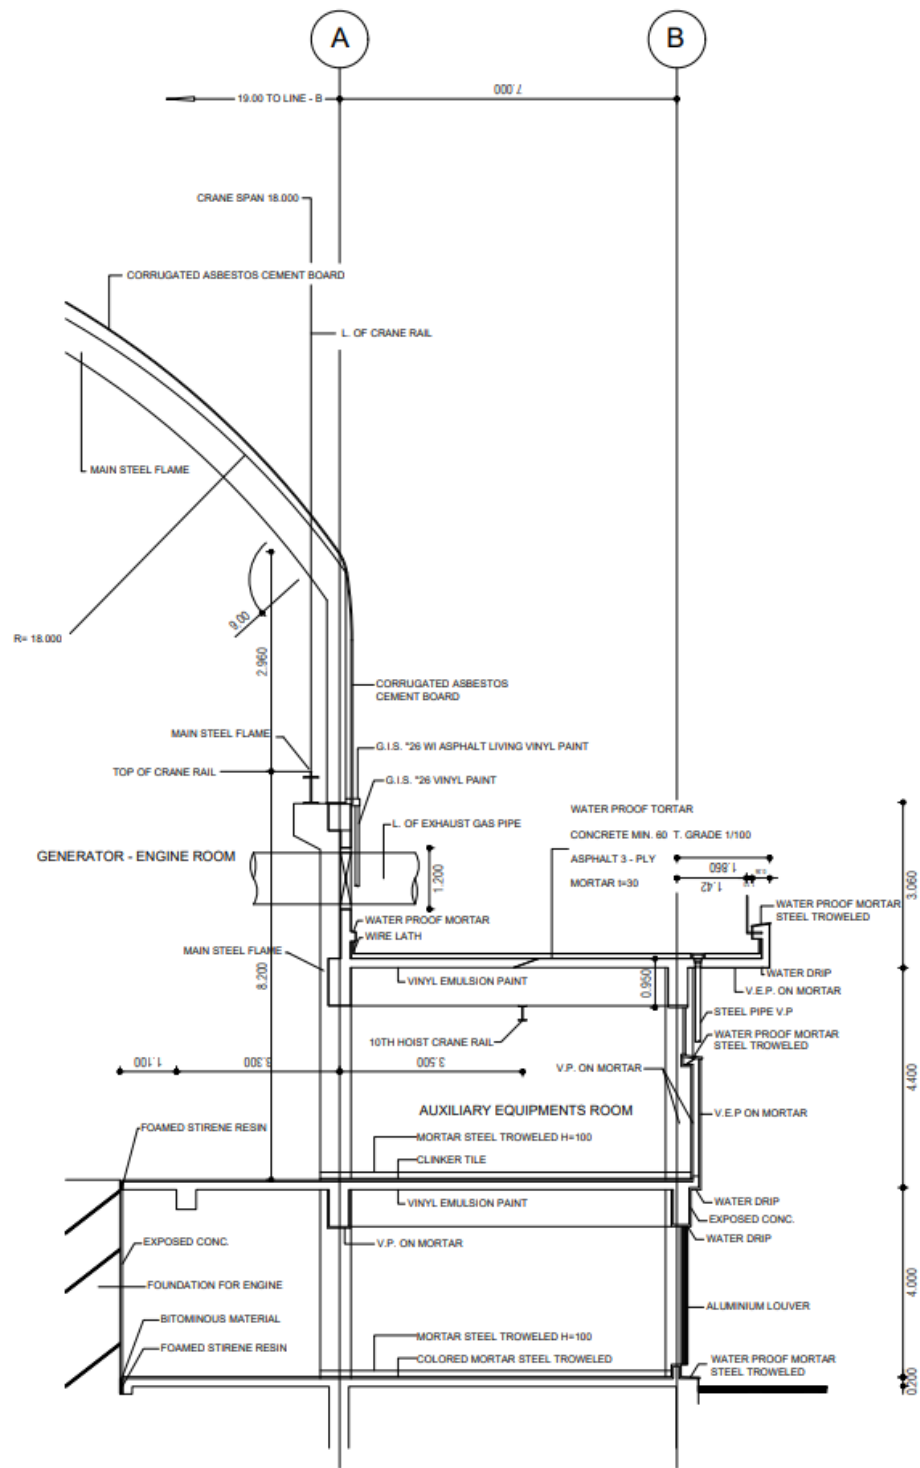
planos de los cortes de la casa de maquinas – AutoCAD
